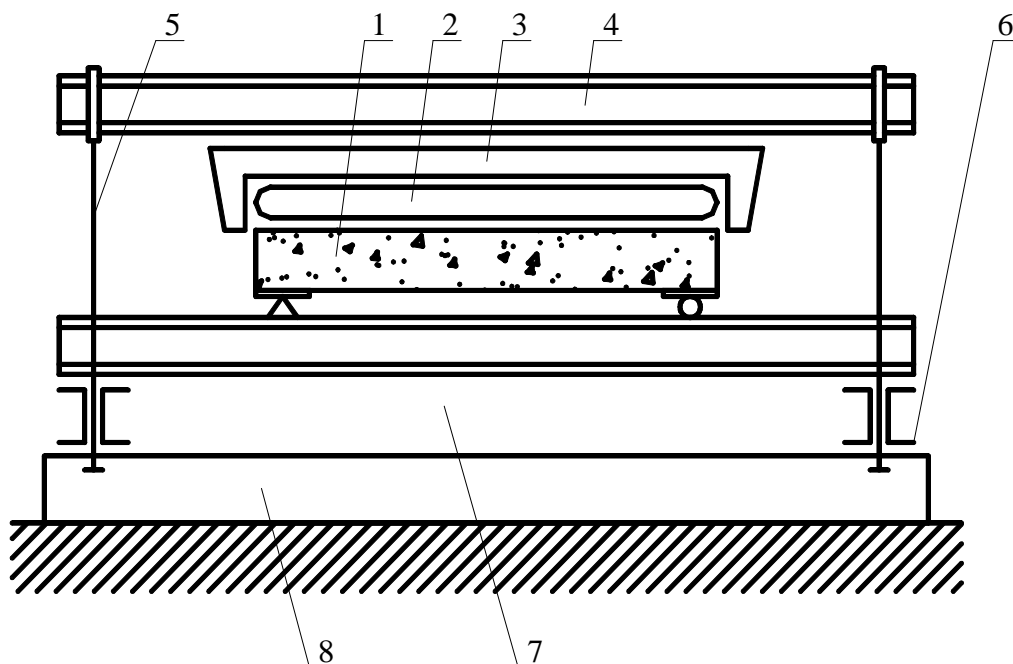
Схема испытания плиты сжатым воздухом: 1 – испытываемая конструкция; 2 – пневматический баллон; 3 – упорный щит с ограничителями; 4 – поперечина; 5 – тяги; 6 – продольные балки; 7 – поперечные опорные балки; 8 – фундамент
